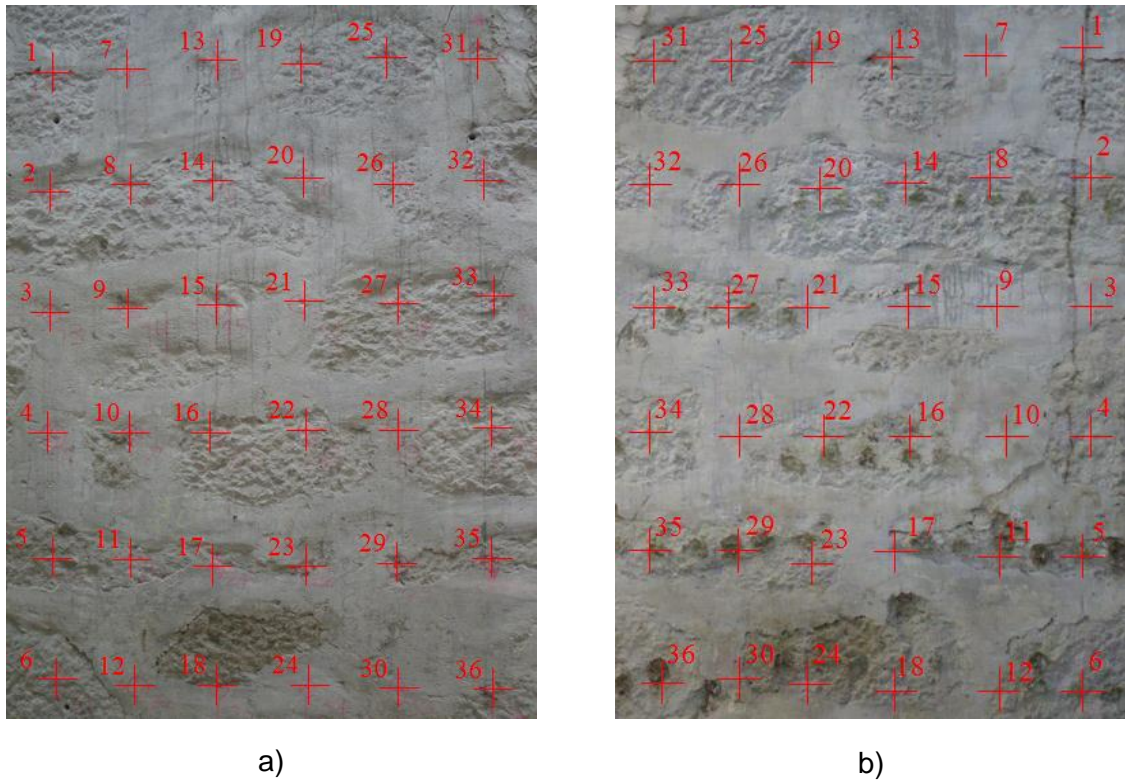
Aspecto dos dois alçados principais da parede testada com a numeração colocada: a) alçado H; b) alçado M.
